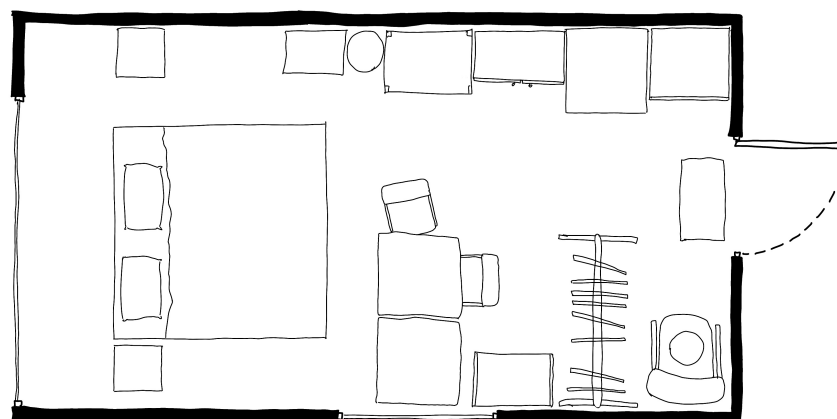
Simulation plan *tiny house* de Gilles et Françoise
